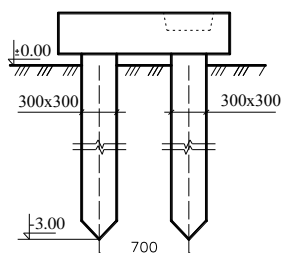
Фундамент з двома палями і збірним залізобетонним ростверком
